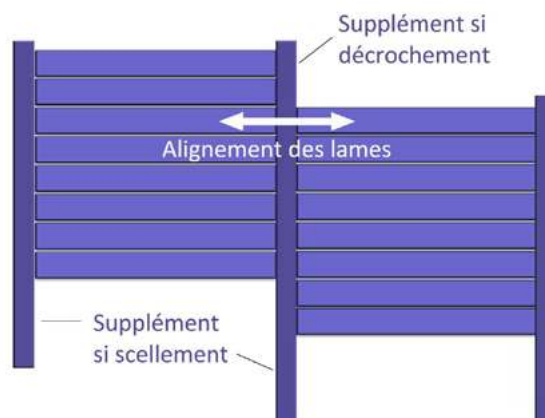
schéma des suppléments de hauteur de poteaux (dessin de Cédric Houel).
